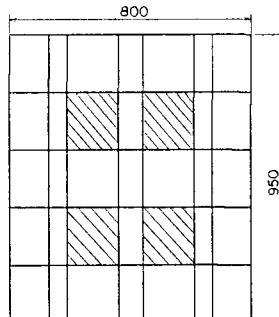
模型平面図(Cタイプは斜線部を逆勾配とした)
